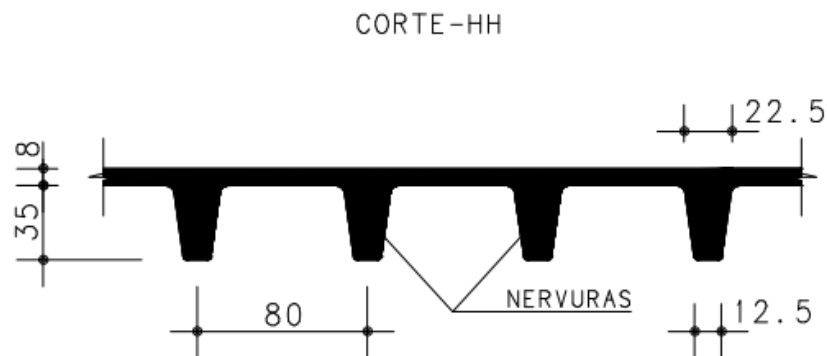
Corte HH – Vista em corte das nervuras da laje. (TQS, versão 2021).
